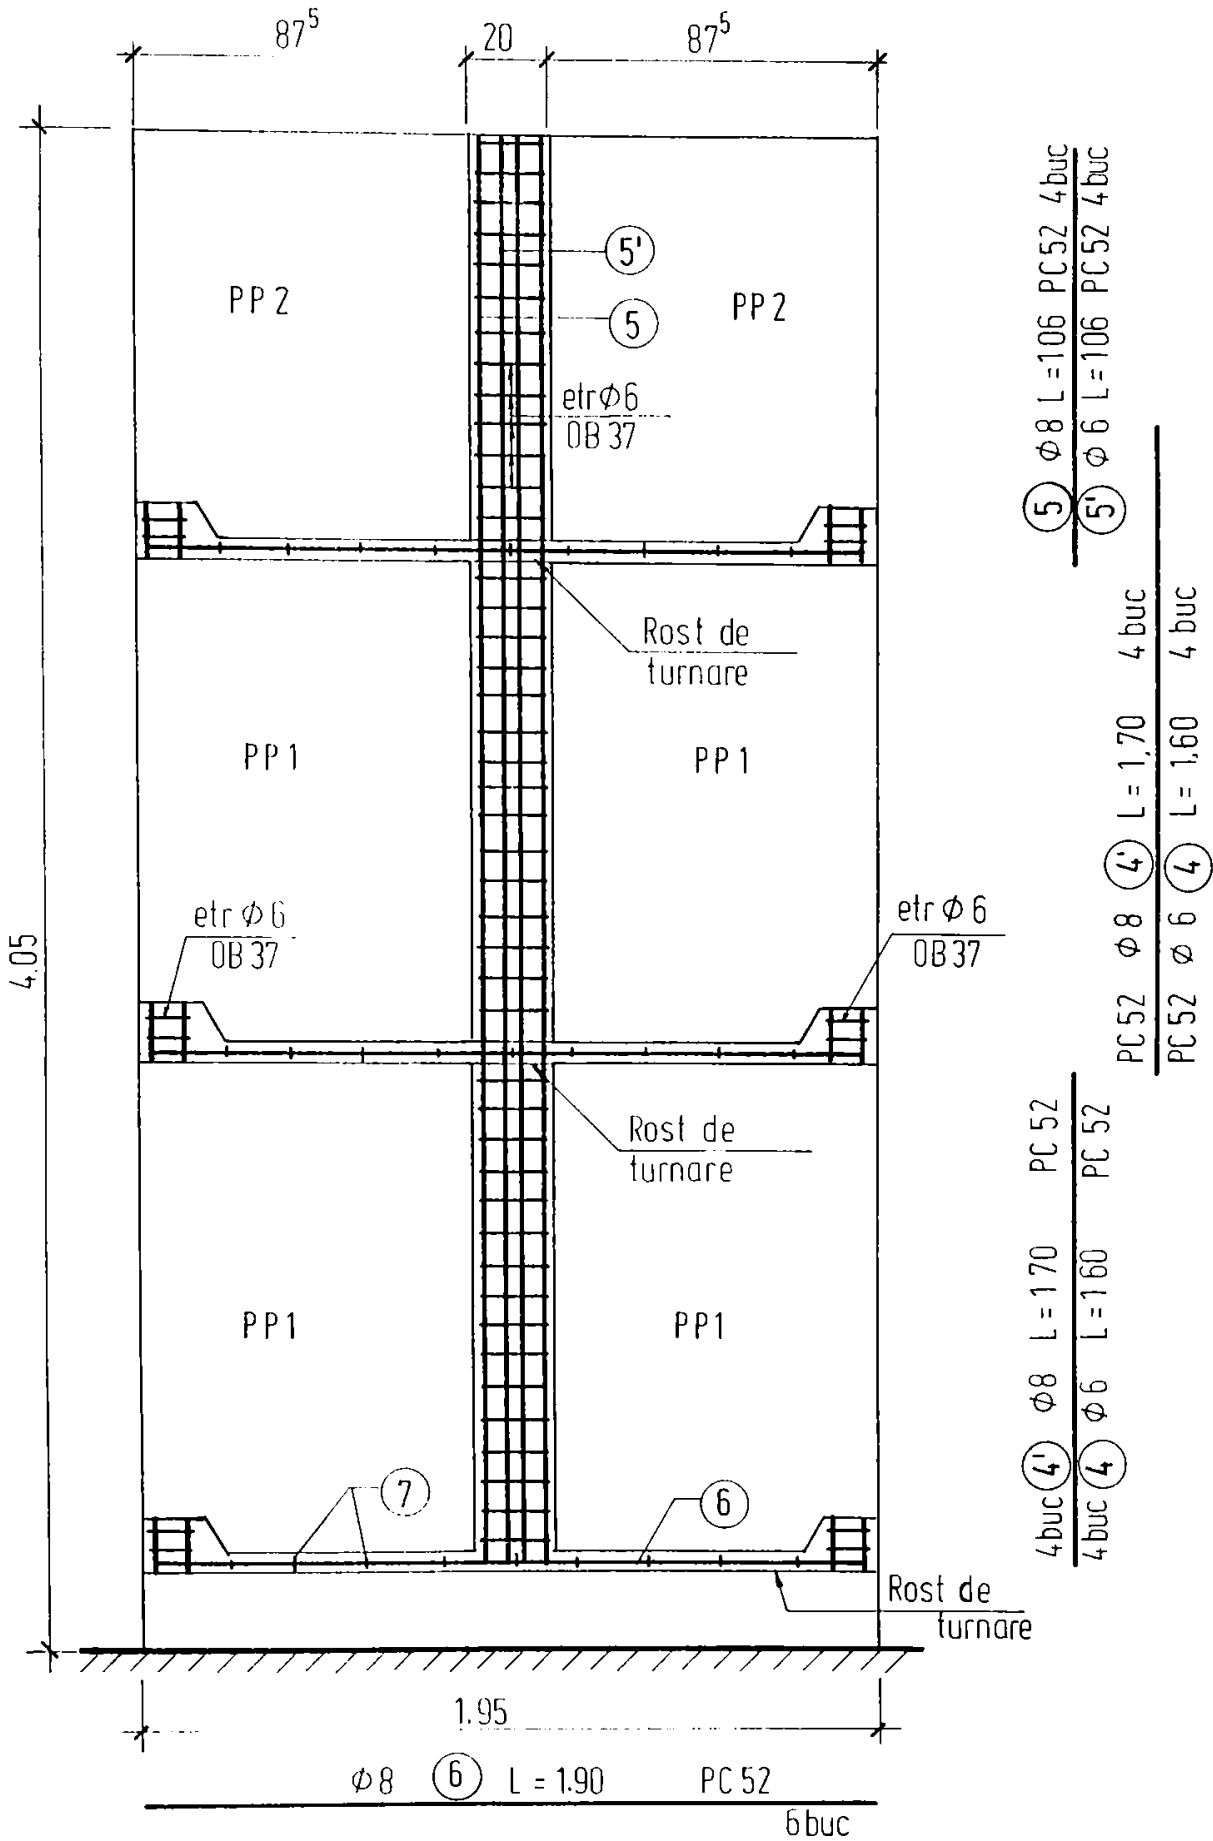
PERETE STRUCTURAL PREFABRICAT - MODEL F2 - ARMARE MONOLITIZĂRI
